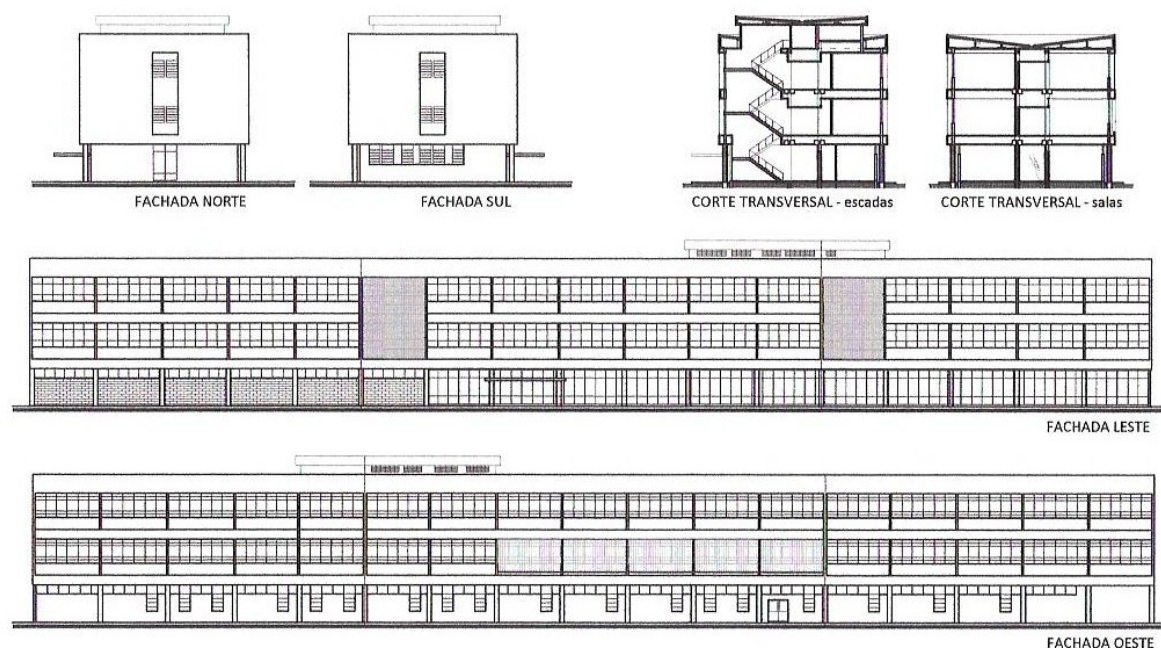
Levantamento físico do edifício – cortes e fachadas
